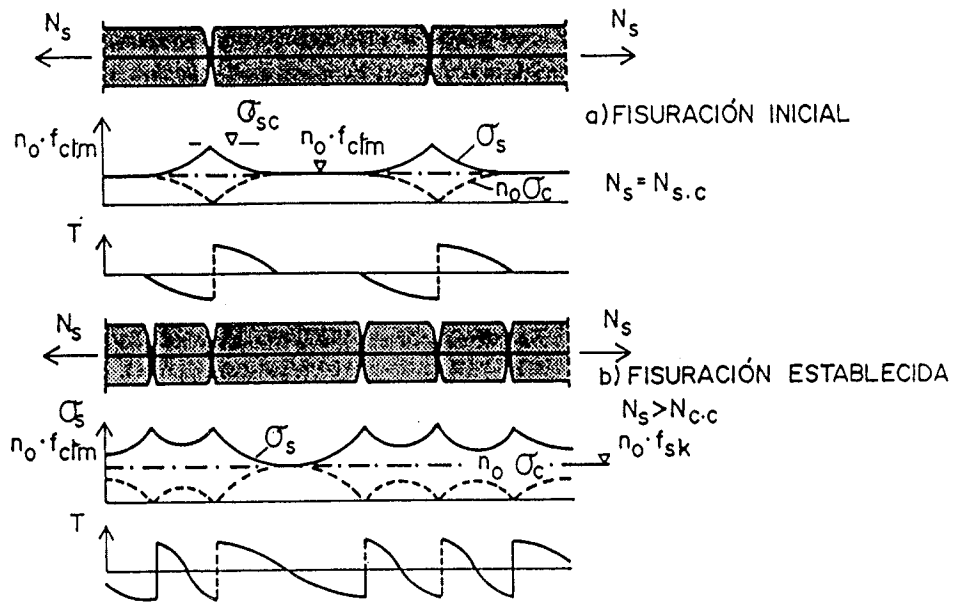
Tensiones en la losa traccionada de hormigón, para la fisuración inicial y las sucesivas.
